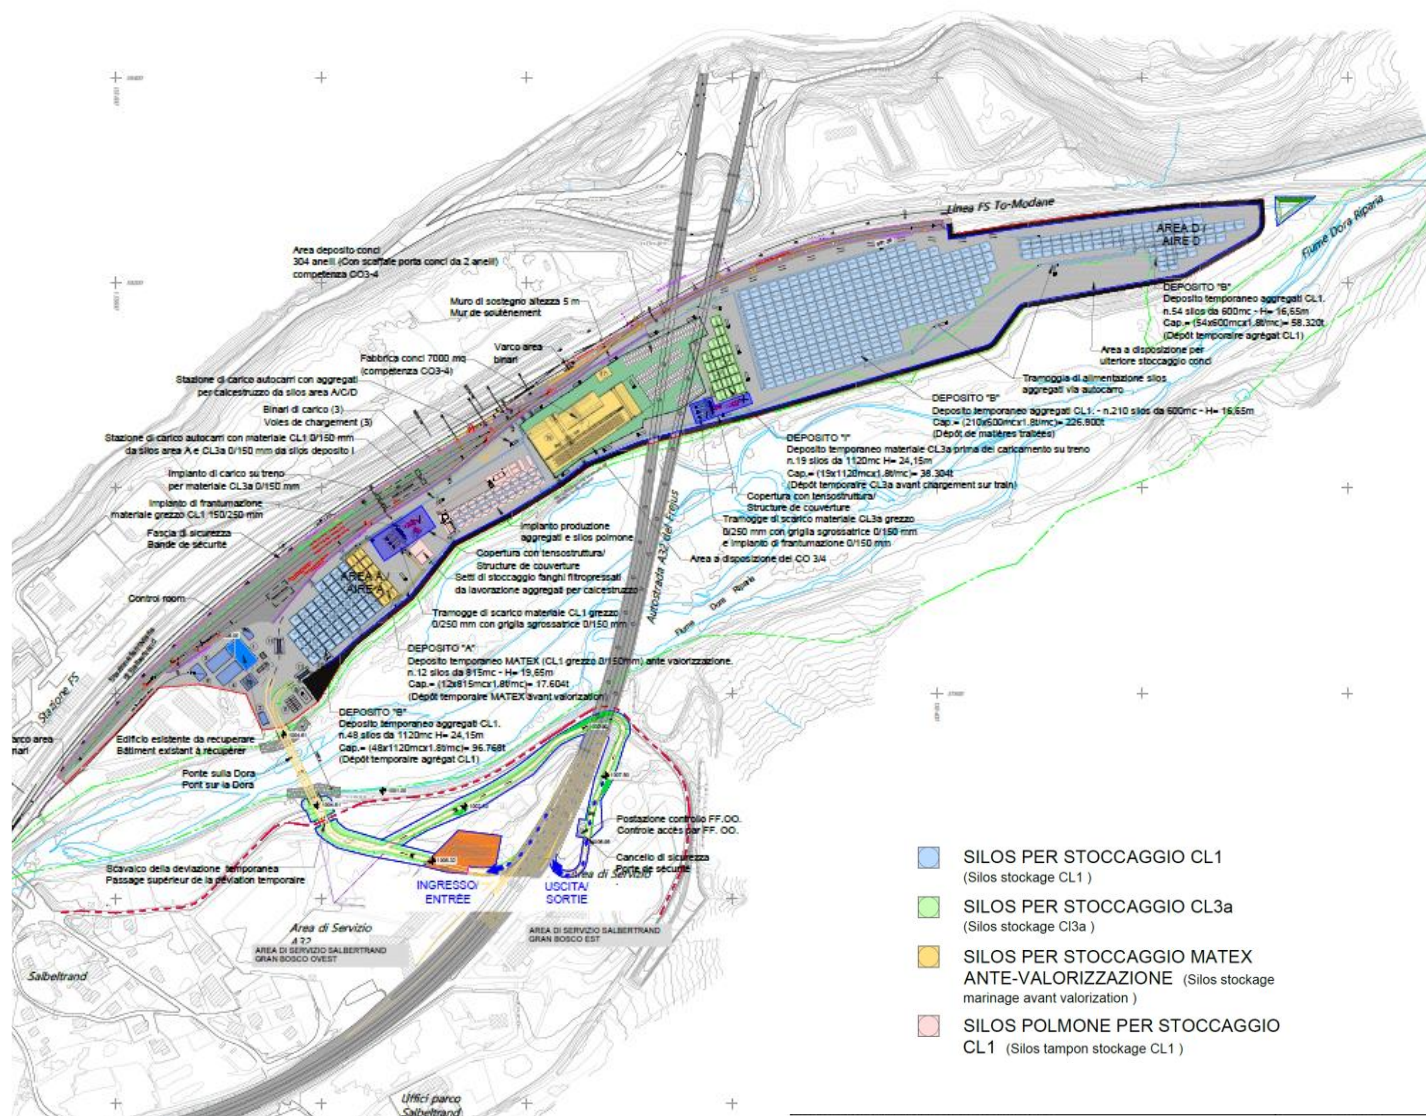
Layout area di cantiere di Salbertrand (conformazione finale aree di cantiere)
